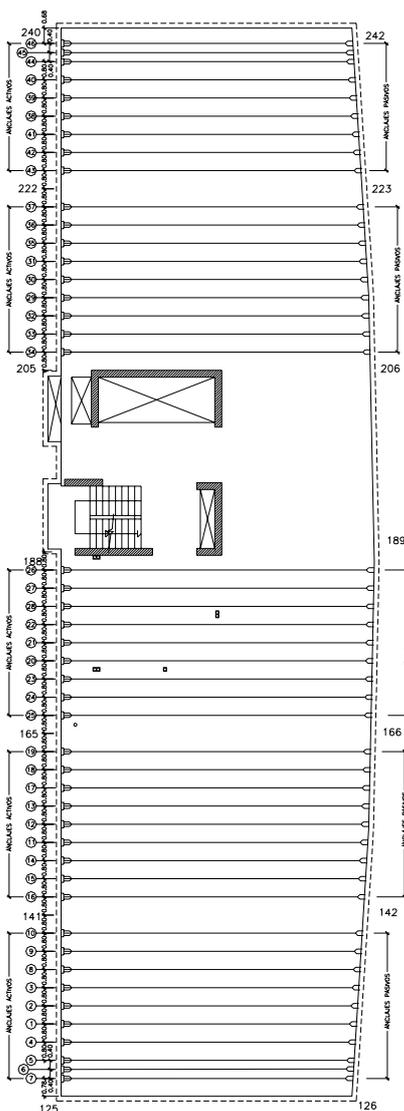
Planta tipo Hotel y Oficinas. Distribución de pretensado.
